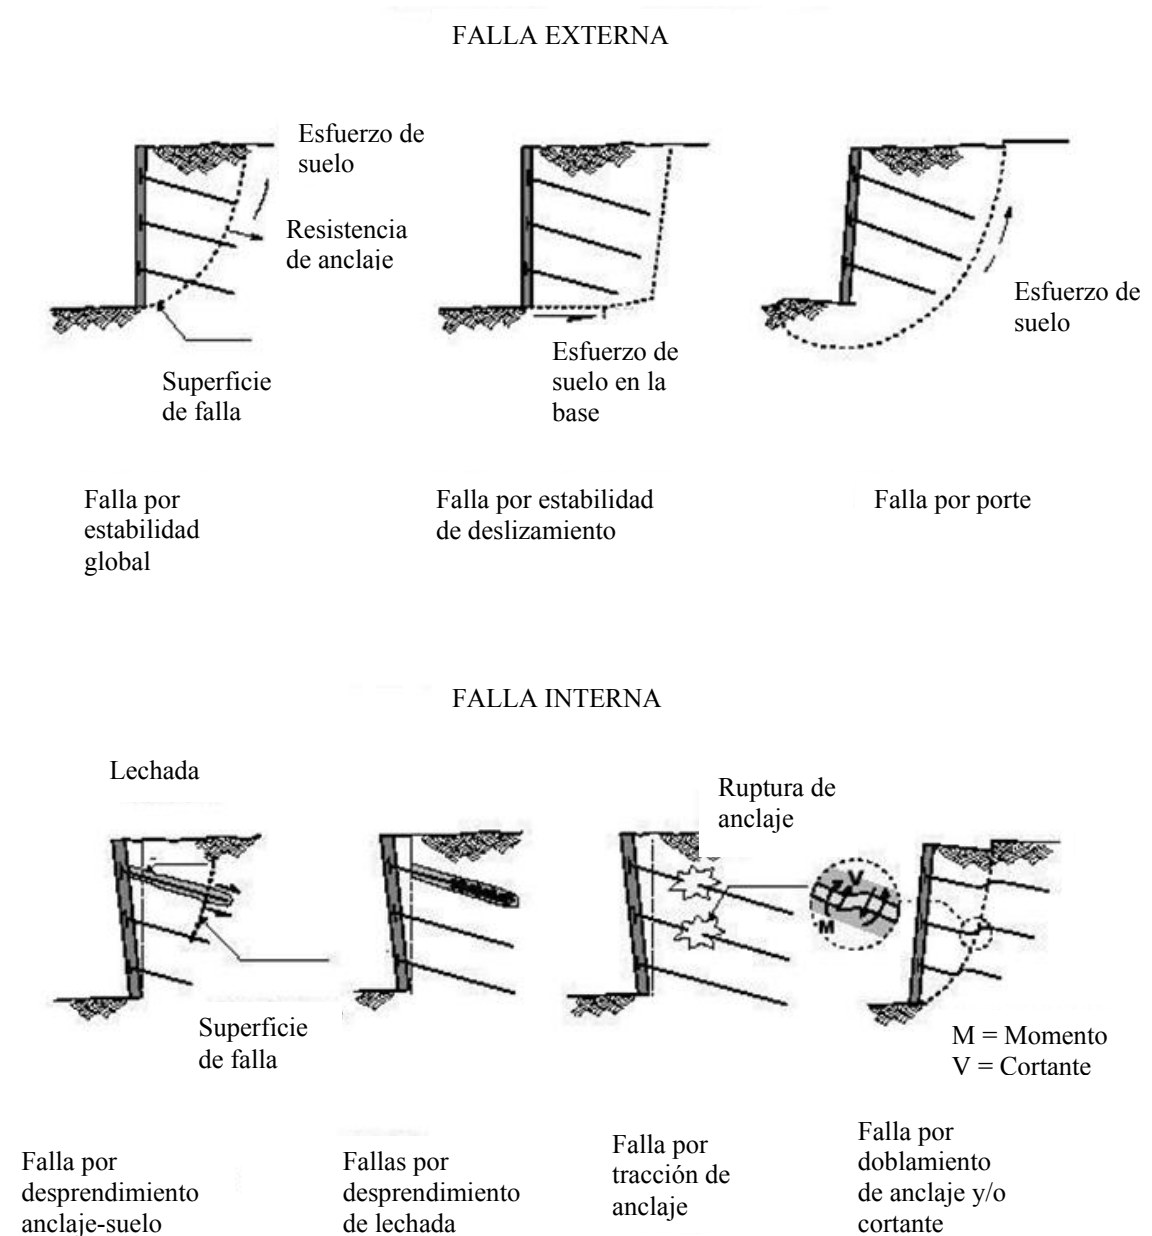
7 Tipos de falla externa e interna de muros de soil nailing.
